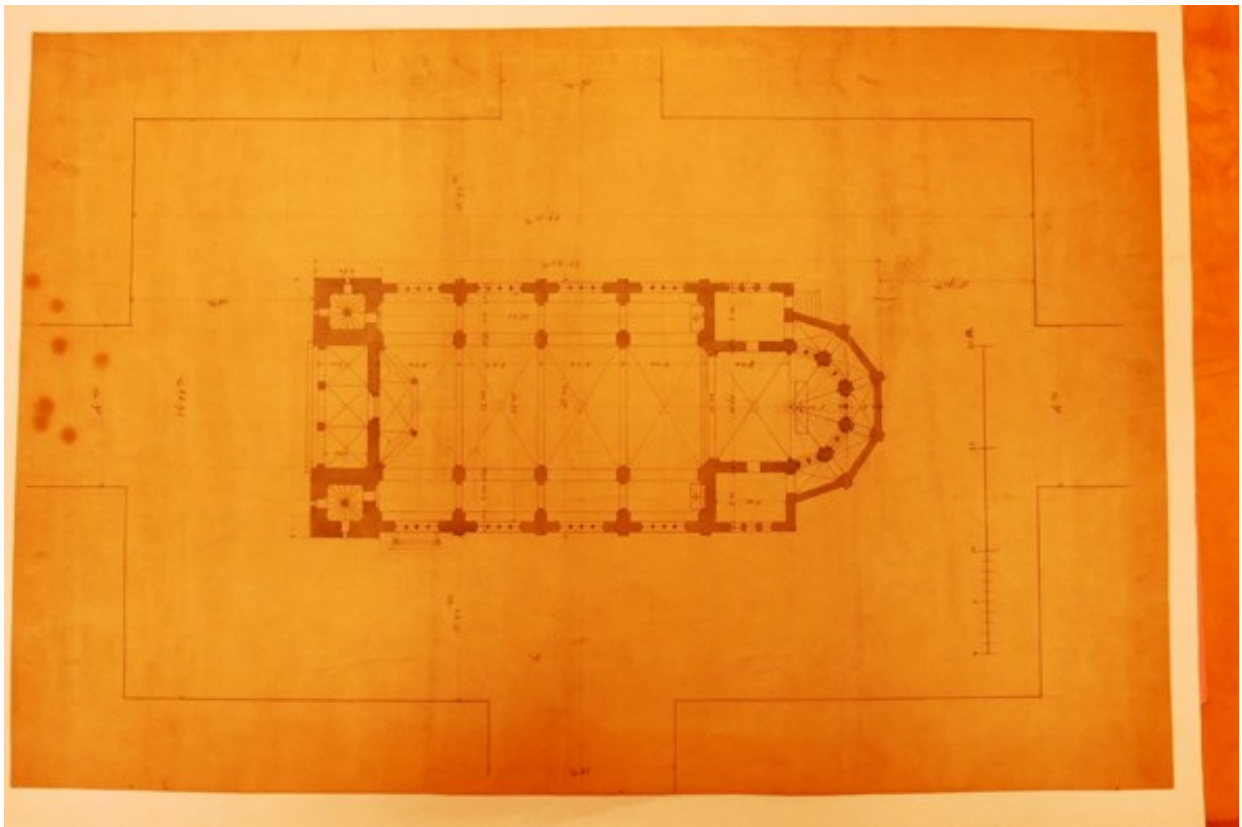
, Kirche mit Zweiturmfassade, Grundriss, ohne Angaben, Bleistift, Wasserfarben auf Karton, 37,3 x 56,2 cm, reproduziert nach Plänen des Wr. Stadt-und Landesarchives, 1030 Wien, Inv. Nr.3653/7.
